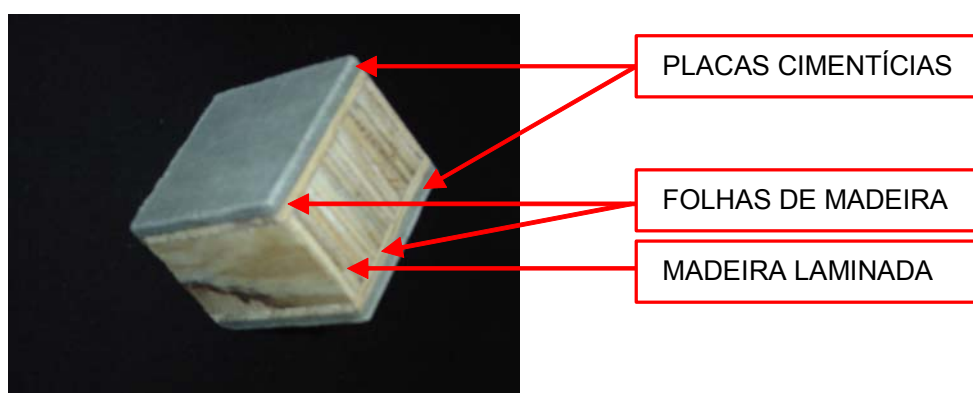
COMPOSIÇÃO DO PAINEL WALL UTILIZADO NAS PAREDES DO PROTÓTIPO
